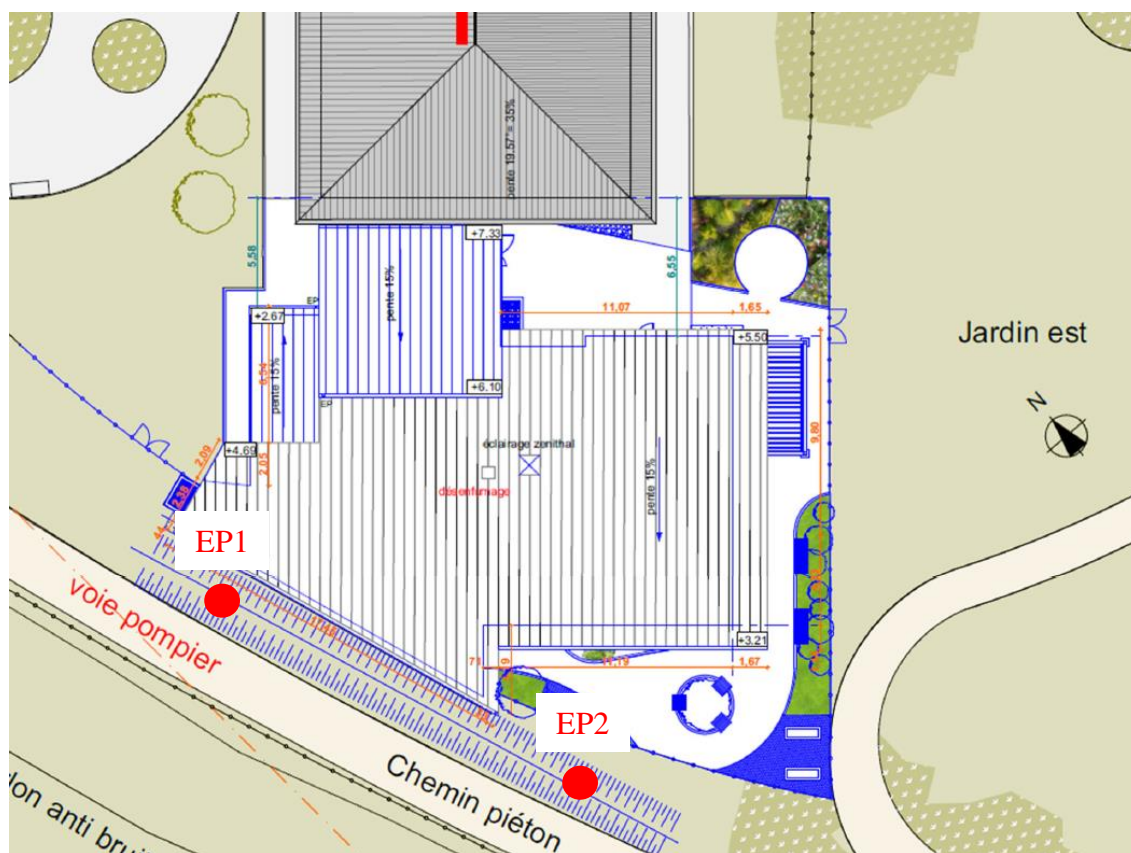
Extrait du plan de masse et du projet d'extension + position des essais d'infiltration - CETEL
